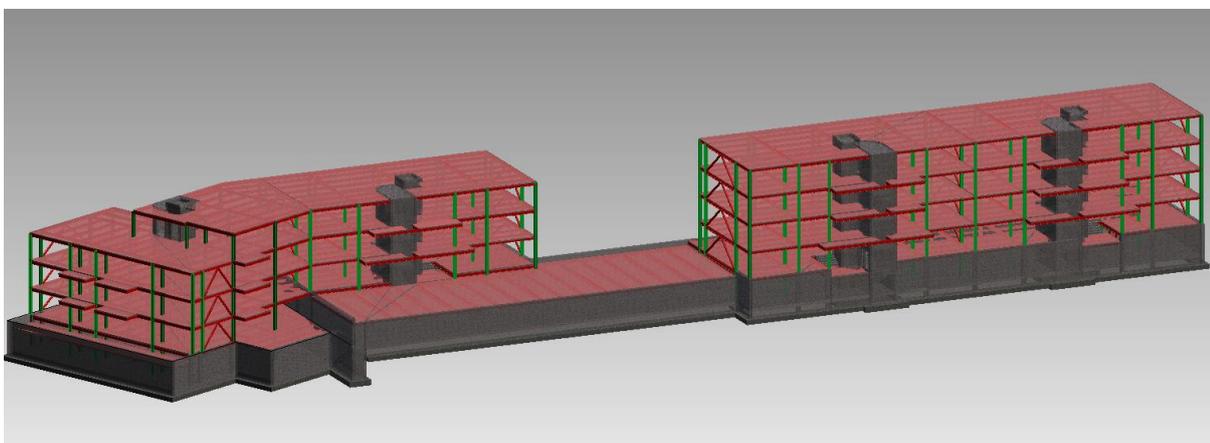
Modelo 3D do projeto de estruturas (Metal + Betão)
